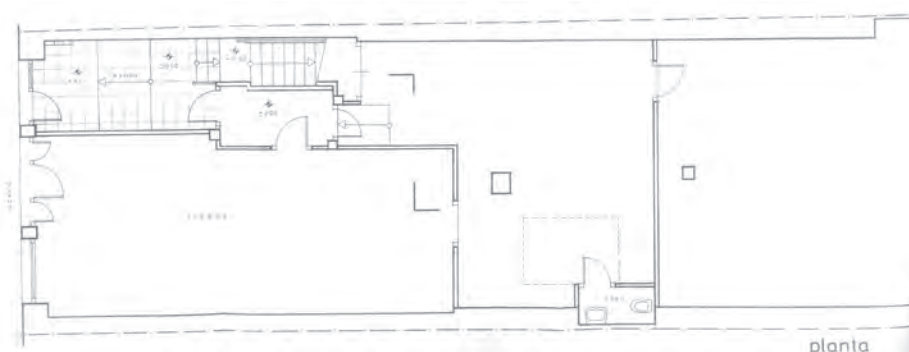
22. 1996 PLANO DE PLANTA BAJA DESPUES DE LA REFORMA DEL PORTAL
